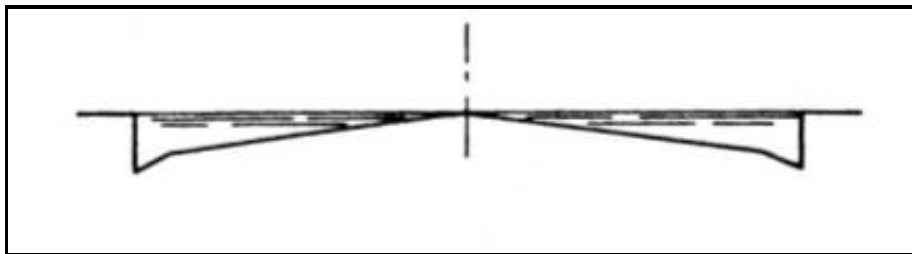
PERFIL TRANSVERSAL TIPICO DE UNA CALLE PAVIMENTADA.
